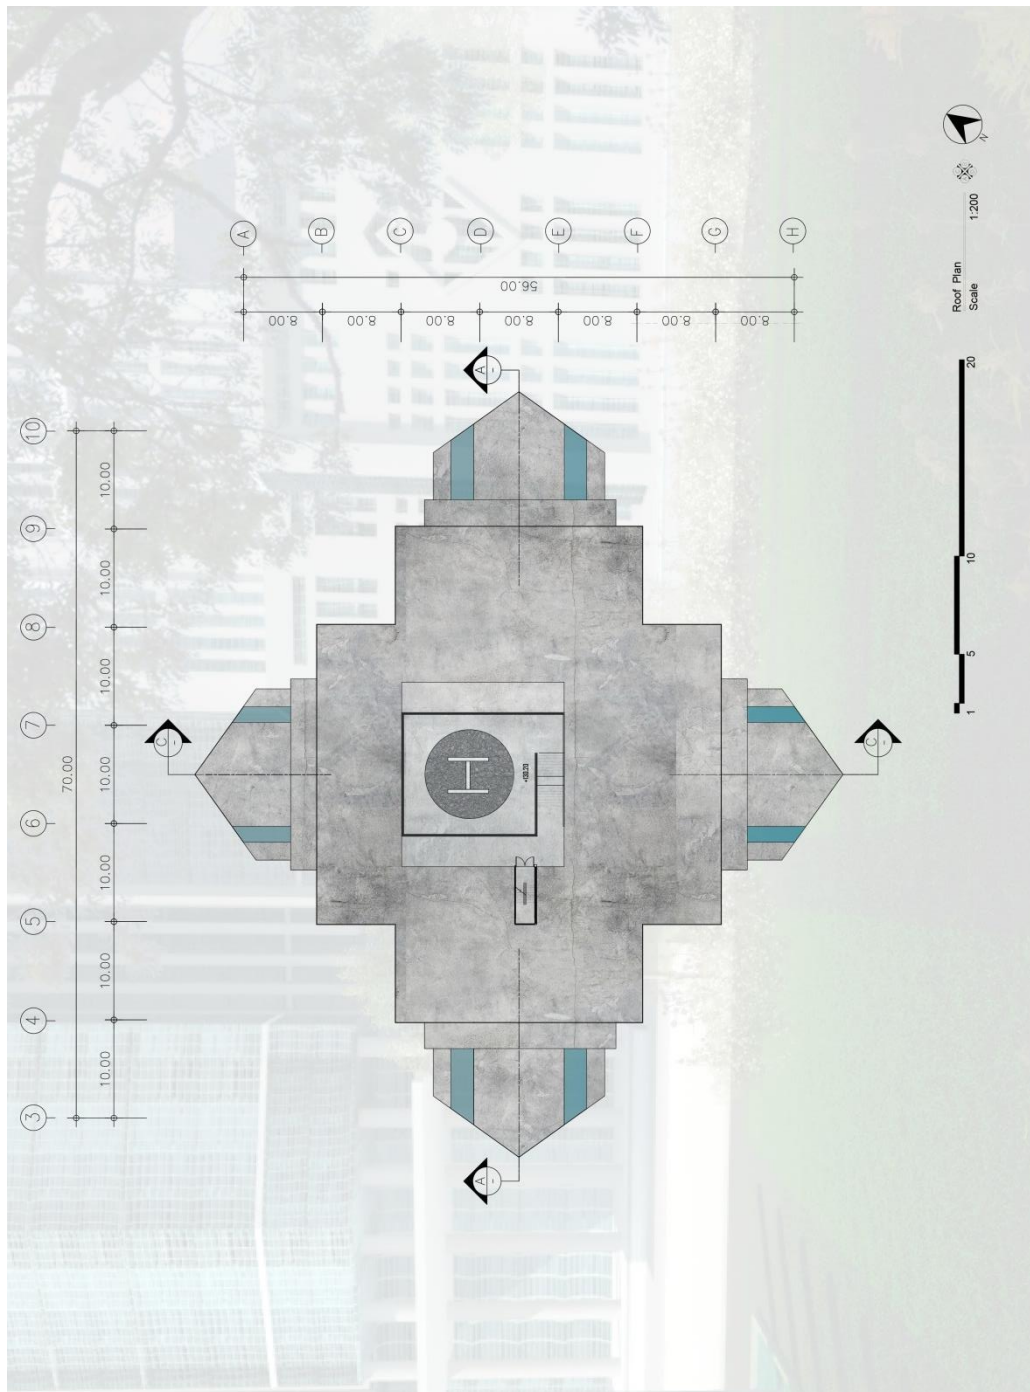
แสดงแบบสถาปัตยกรรม SESTEM FLOOR PLAN
